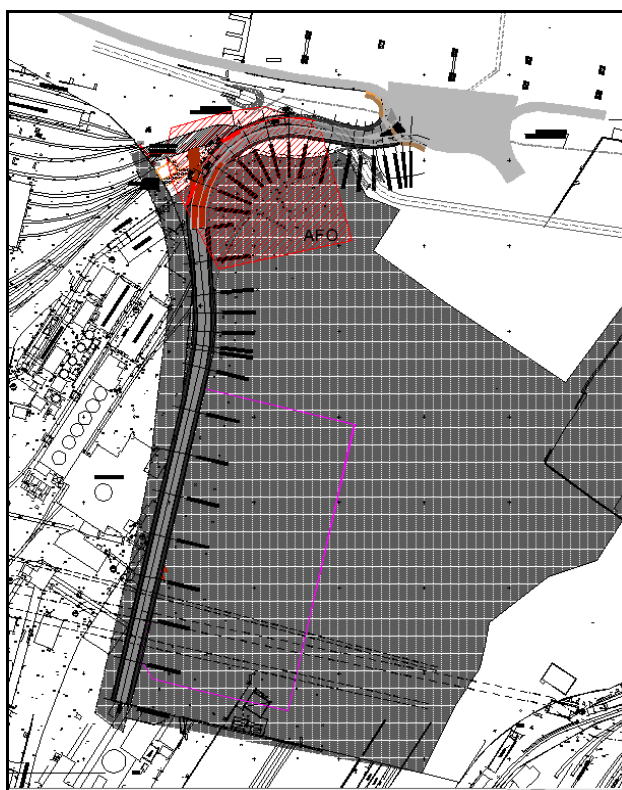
Stralcio planimetrico con individuazione dell'area AFO.
